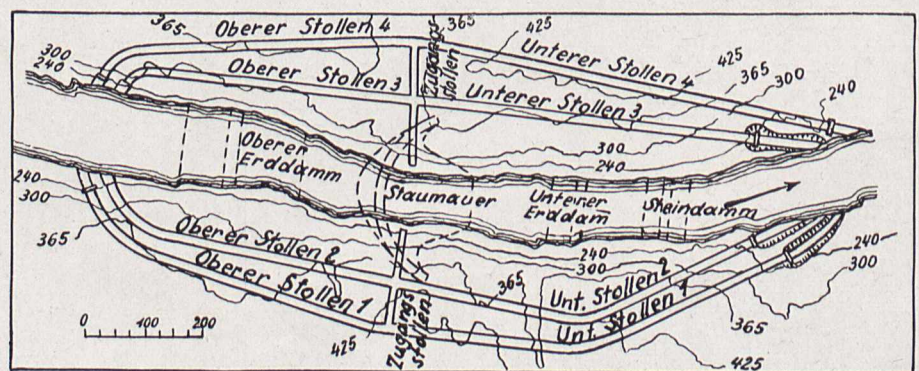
Grundriß der Hoover-Damm-Stauanlage und der Ableitungsstollen
